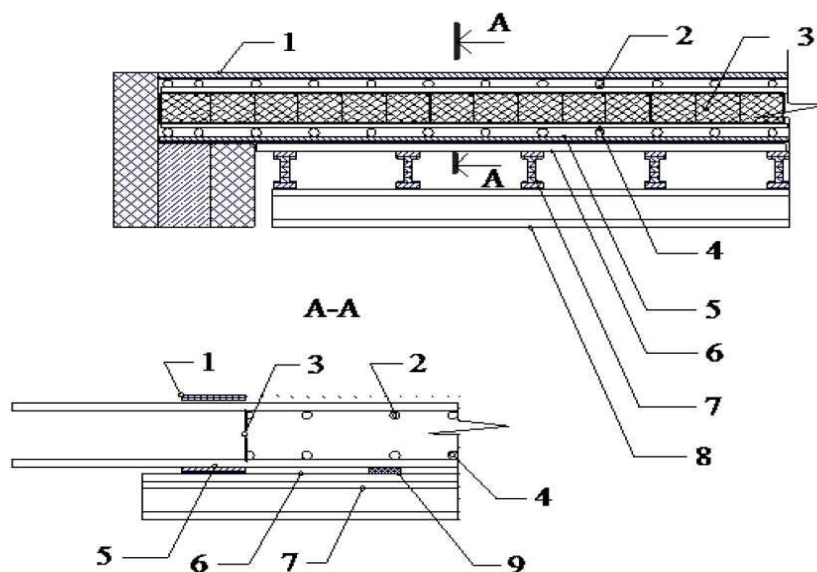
1 - верхняя доска для формирования защитного слоя; 2 - верхняя арматурная сетка; 3 - сетка-рабца закрепленная на арматурный каркас; 4 - нижняя арматурная сетка; 5 - нижняя доска для формирования защитного слоя; 6 - палуба (фанера); 7 - поперечная балка; 8 - продольная балка; 9 - фиксатор арматуры.
